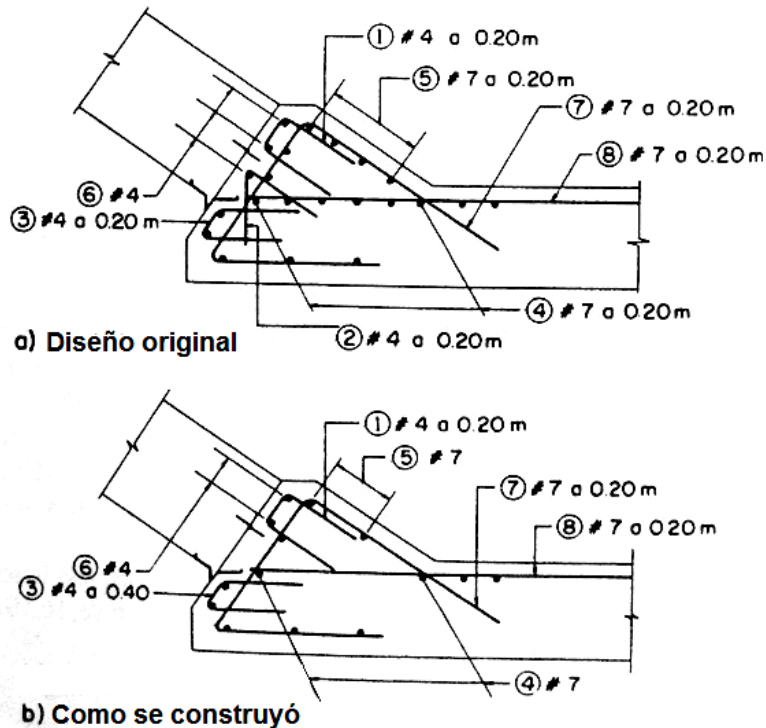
ACERO EN LA JUNTA PERIMETRAL EN LA PRESA DE SALVAJINA (HACELAS Y RAMÍREZ, 1987).
